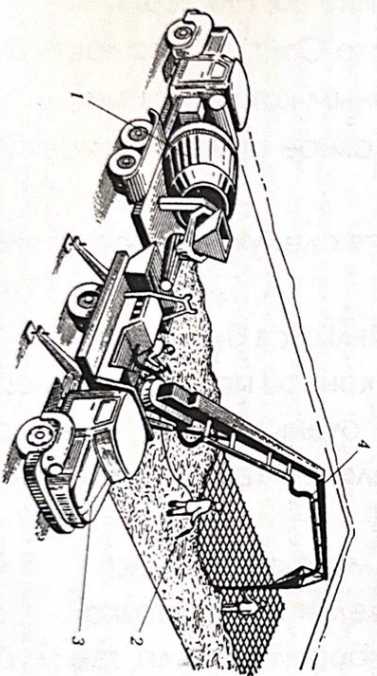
Укладка бетонной смеси автобетононосителями:
